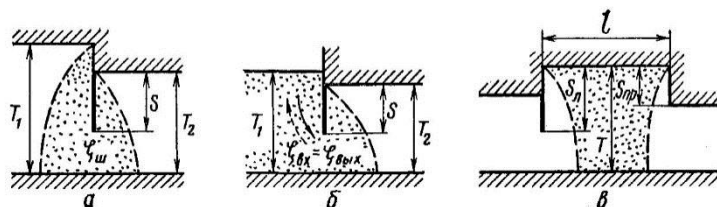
Расчетные элементы подземного контура и фрагменты основания: а – внутренний шпунт или вертикальный уступ; б – входной (выходной); в – горизонтальный
